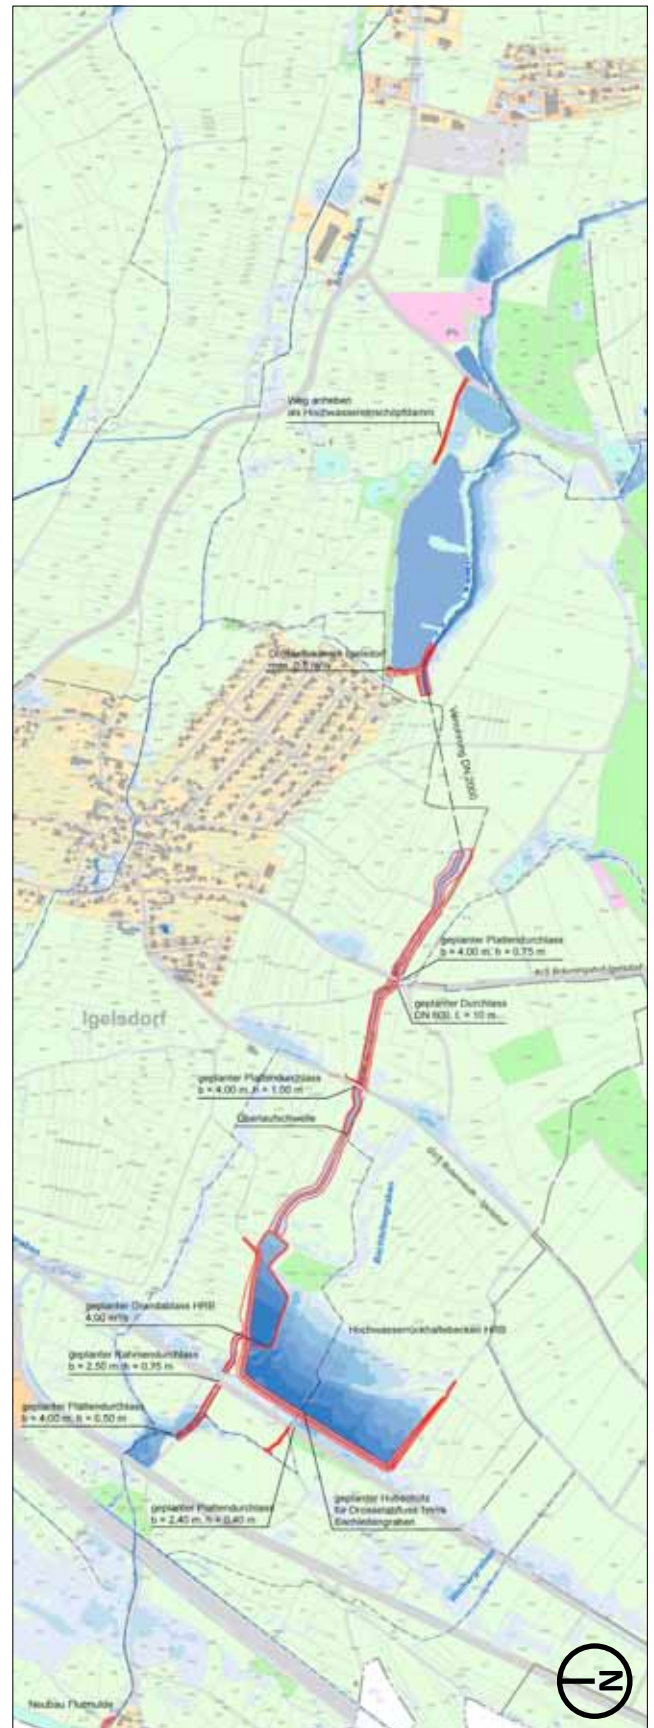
Geplante Hochwasserschutzmaßnahmen, Süableitung (*)
